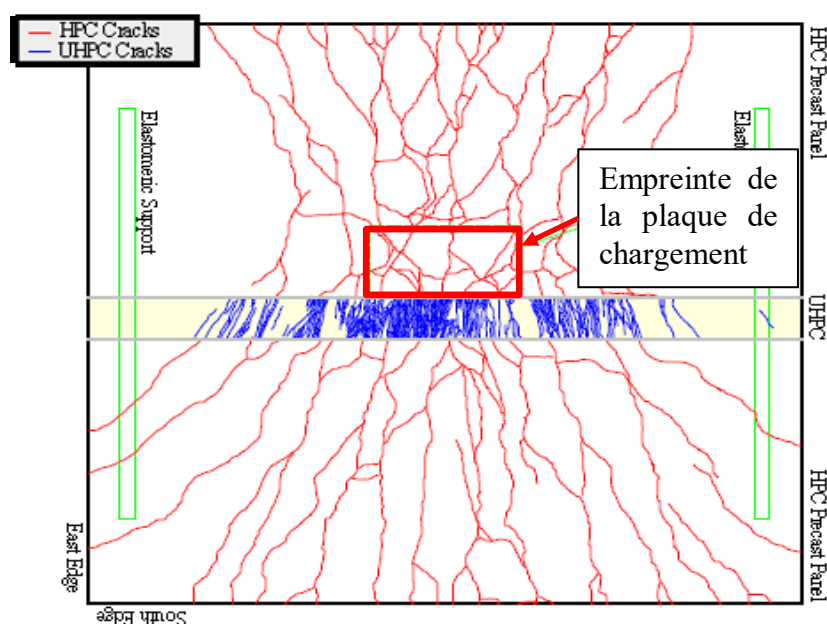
Fissuration sous la dalle en BHP avec joint de connexion transversal (Graybeal, 2010)
